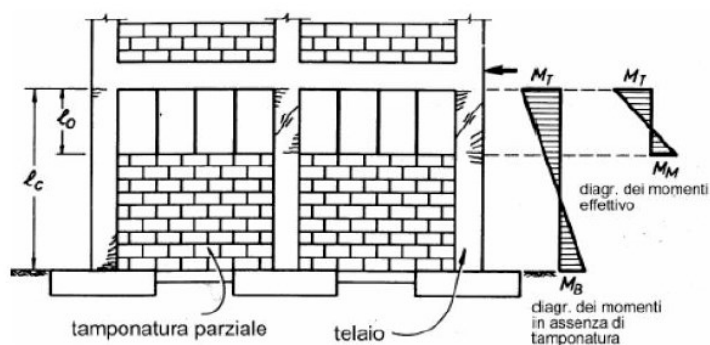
Configurazione geometrica critica del tamponamento rispetto al telaio
